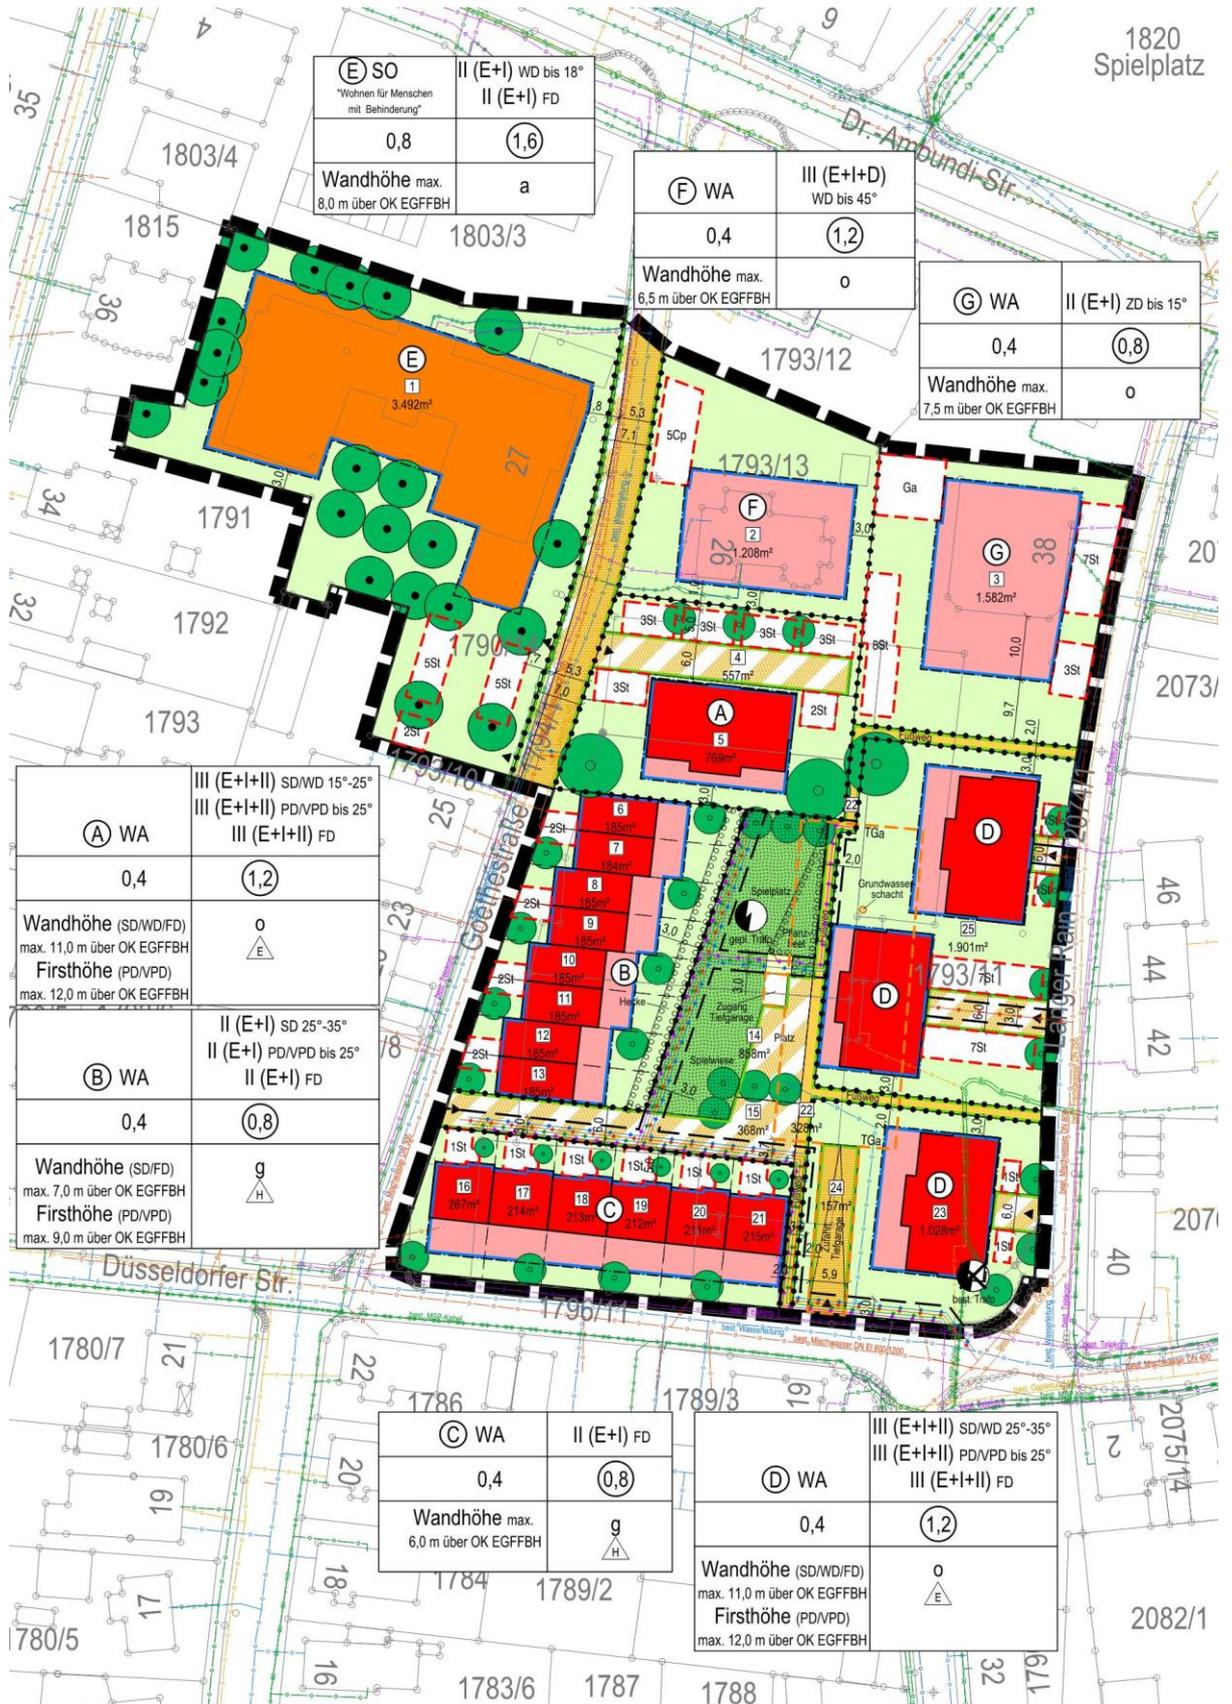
Bebauungsplan Entwurf, in der Fassung vom 15.02.2017
